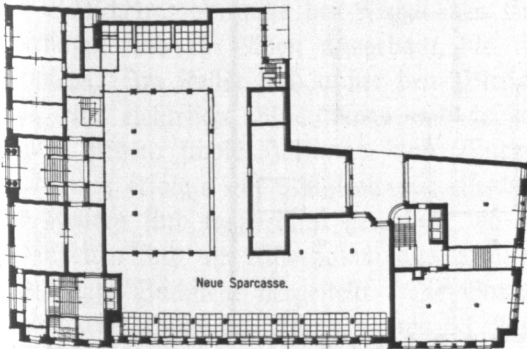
Neue Sparkasse, Grundriß des Erdgeschosses.
